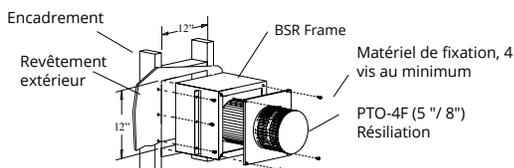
Installation d'une terminaison PTO avec le cadre BAR.
